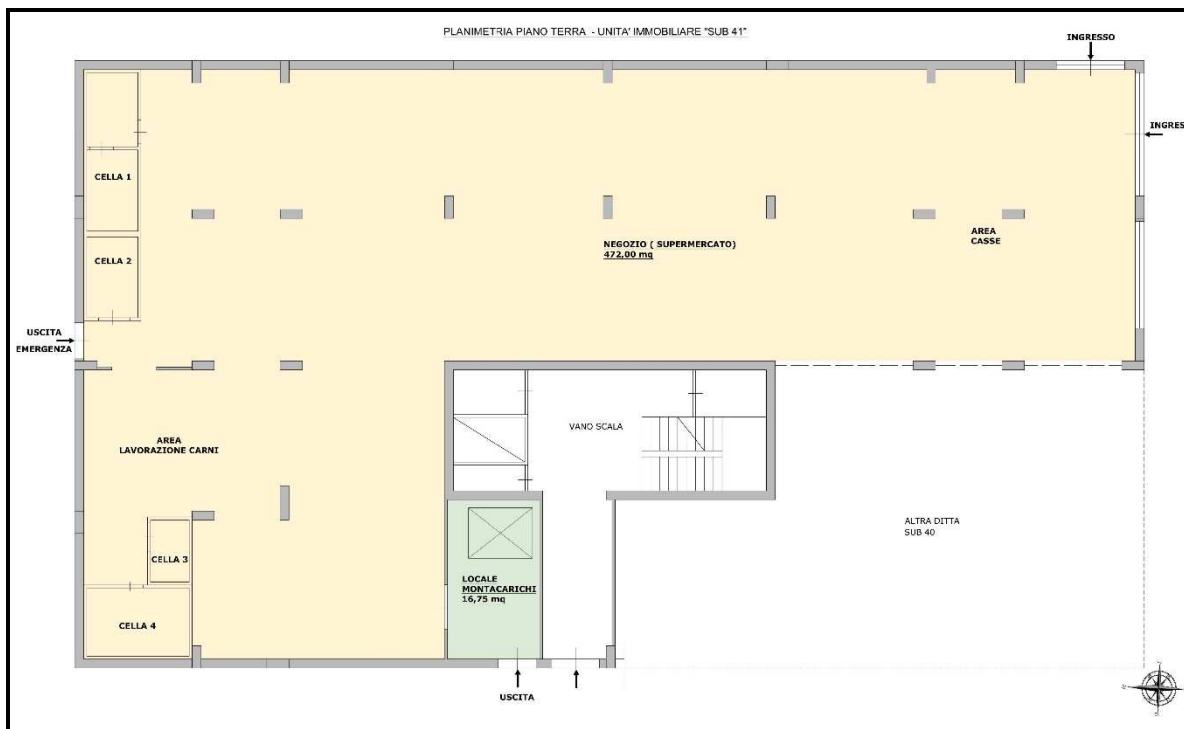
Planimetria stato di fatto immobile Lotto 1 (sub 41)
